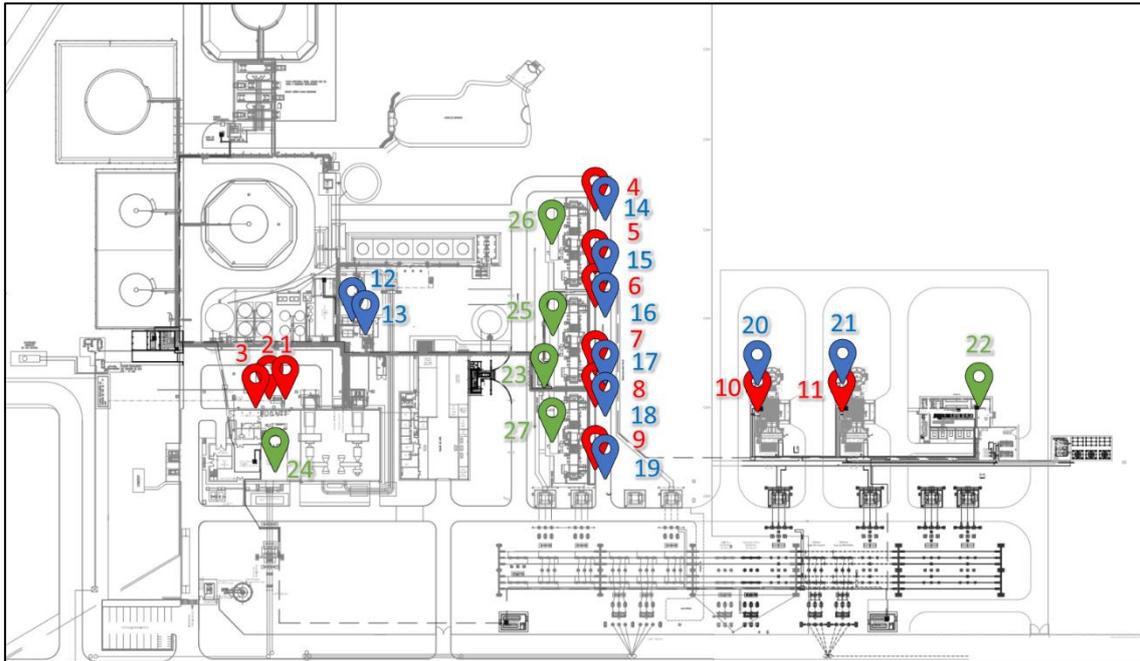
Layout de planta y detalle de caudalímetros de combustible – fuente: (C.T. Modesto Maranzana, 2022)
